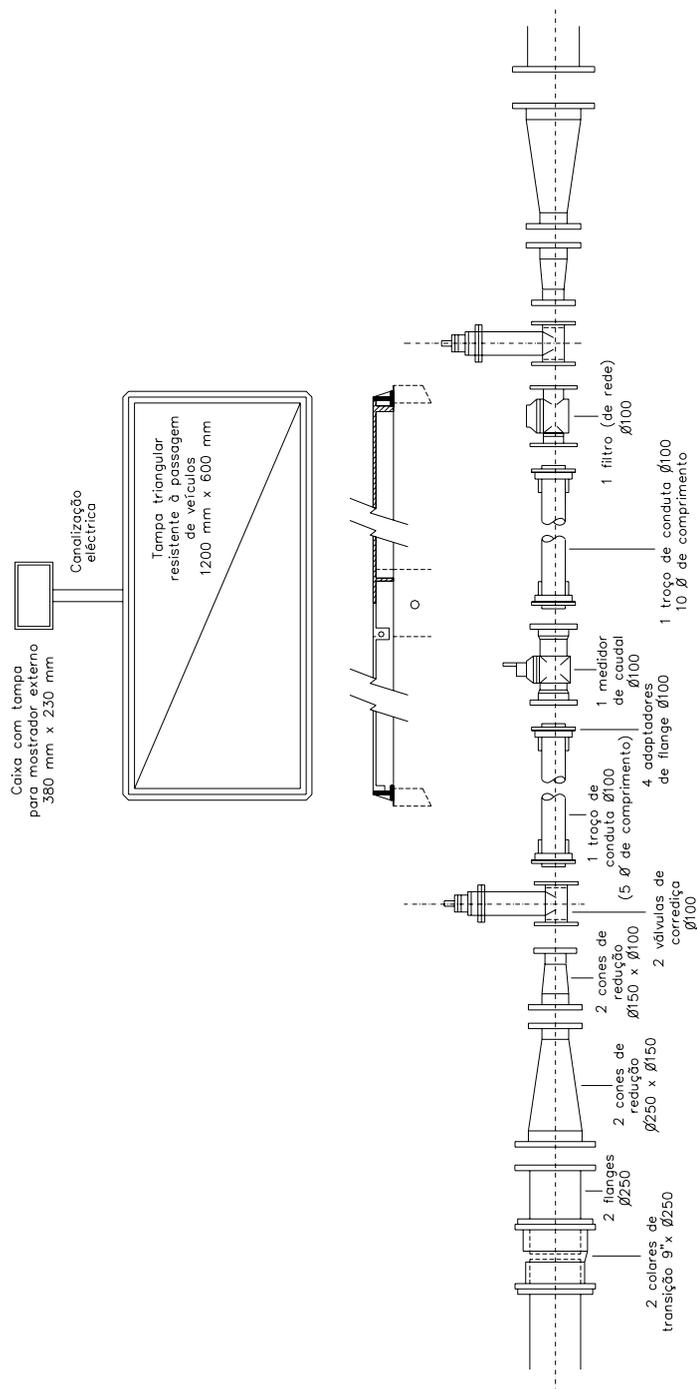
Exemplo de instalação de medidor mecânico de 100 mm instalado em conduita de 225 mm, com 10 diâmetros de tubagem a montante e 5 a jusante, e válvulas e filtro exteriores à câmara
